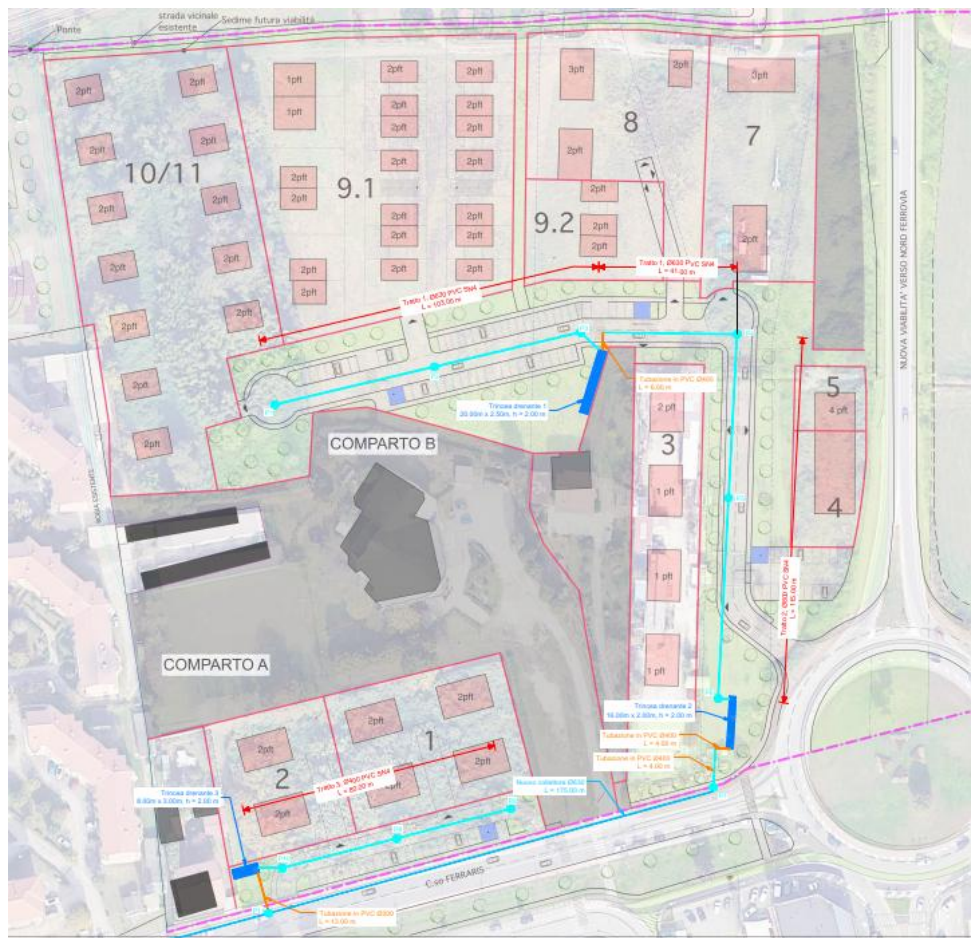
Schema planimetrico della rete di fognatura bianca in progetto.
